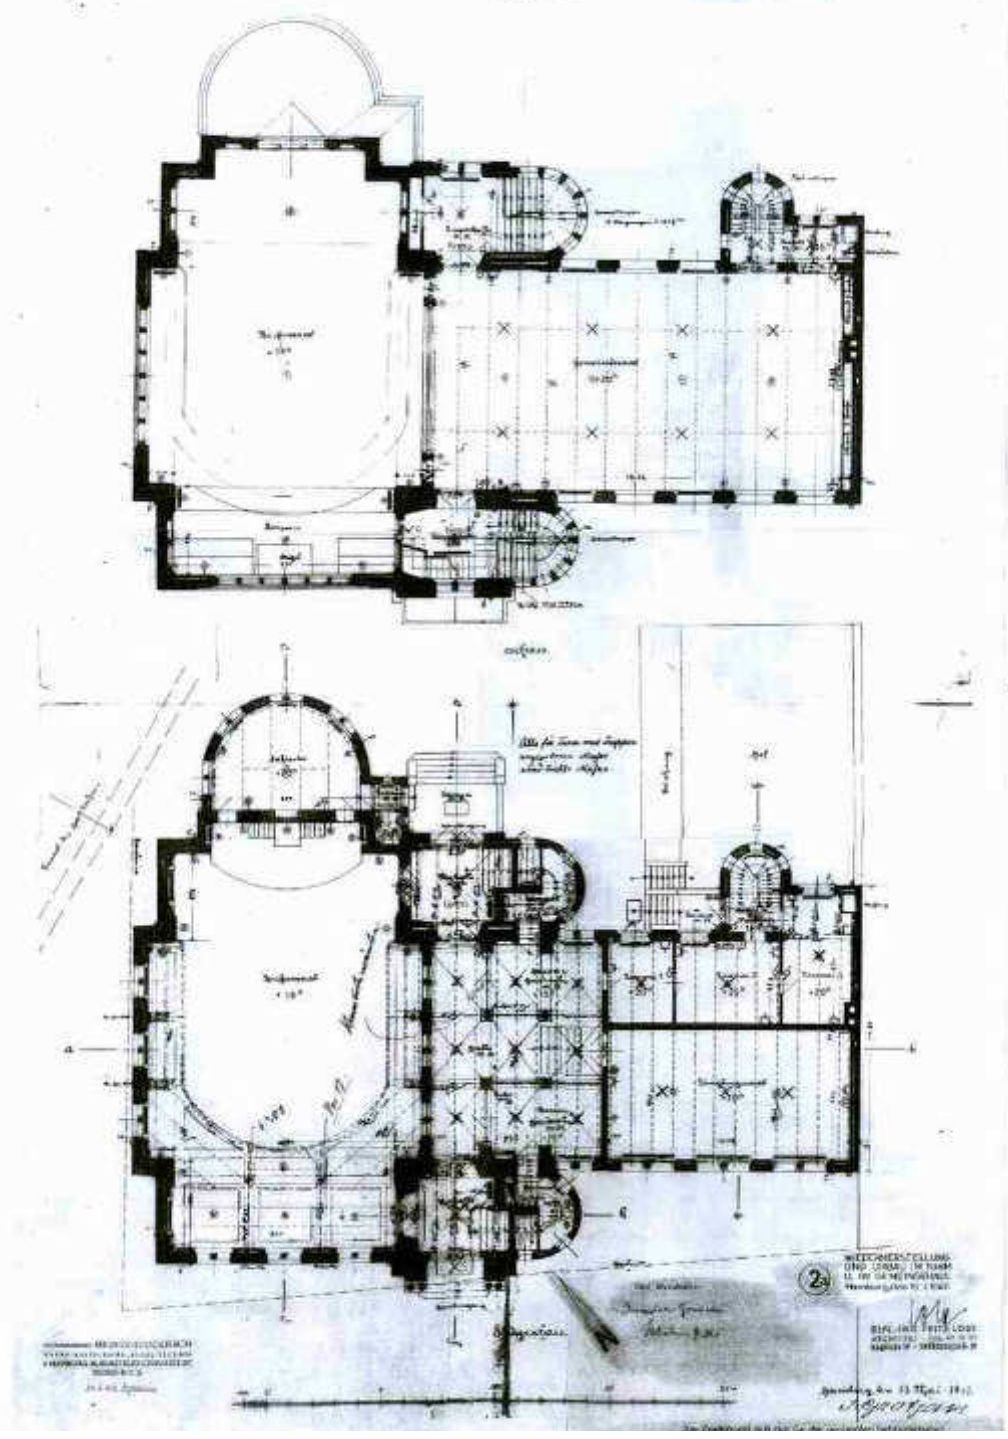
Grundrisse der Jerusalem-Kirche.
